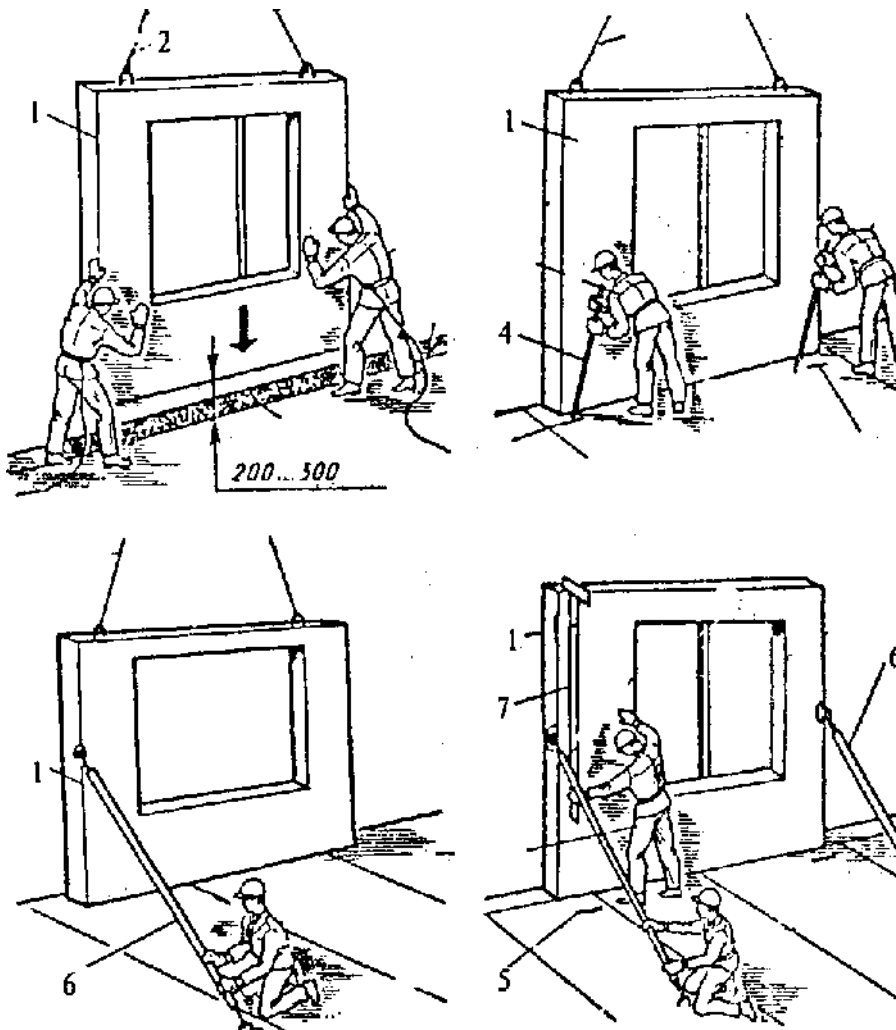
Схема последовательного монтажа наружной стеновой панели: а) опускание стеновой панели, б) выверка
